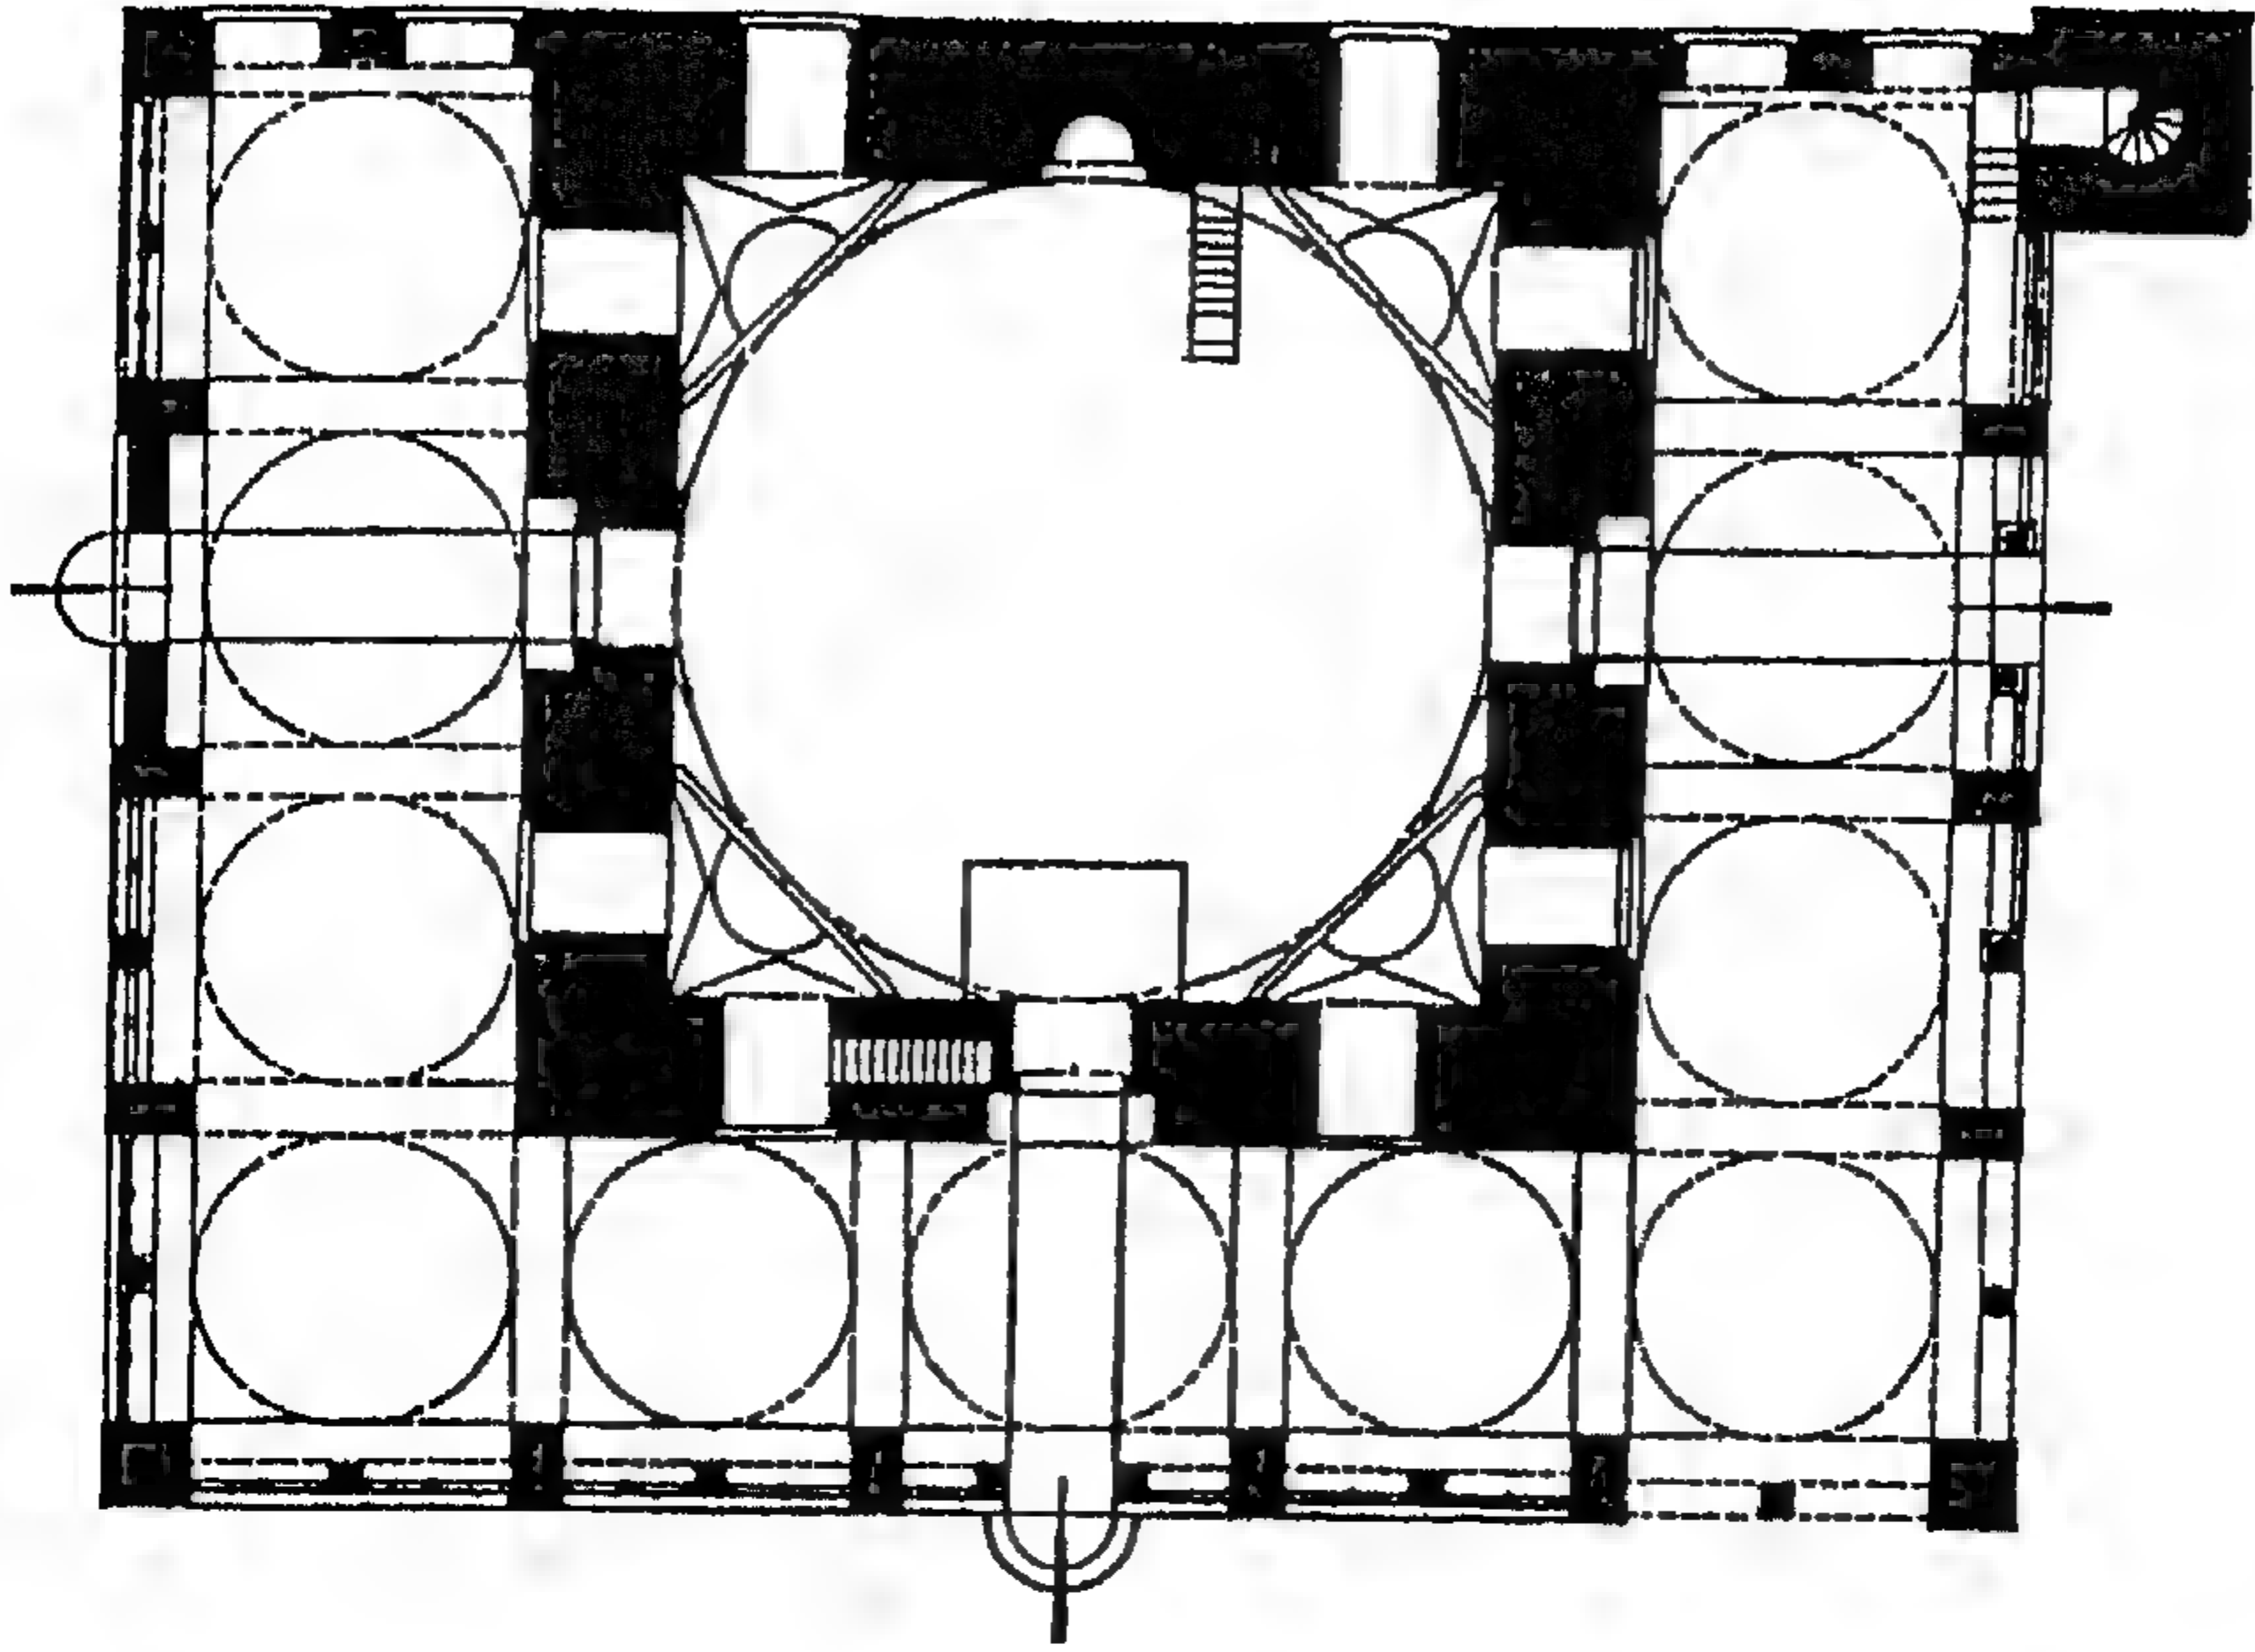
مسقط أفقي لجامع التي برموق بالقاهرة .
